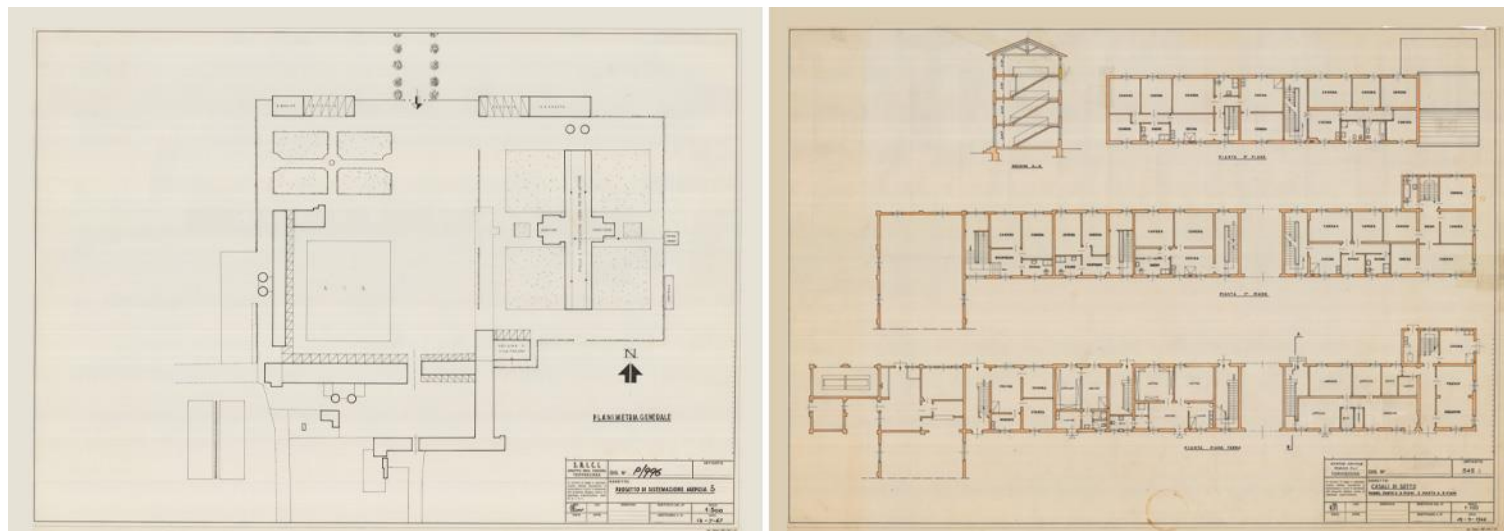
Agenzia 5. Disegno della sistemazione planimetrica generale (sinistra); sezione e pianta piano terra, primo piano e secondo piano (destra).
